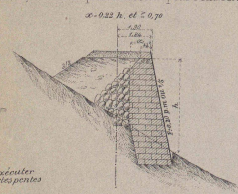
Mur de soutènement en maçonnerie de pierres sèches pour remblai
